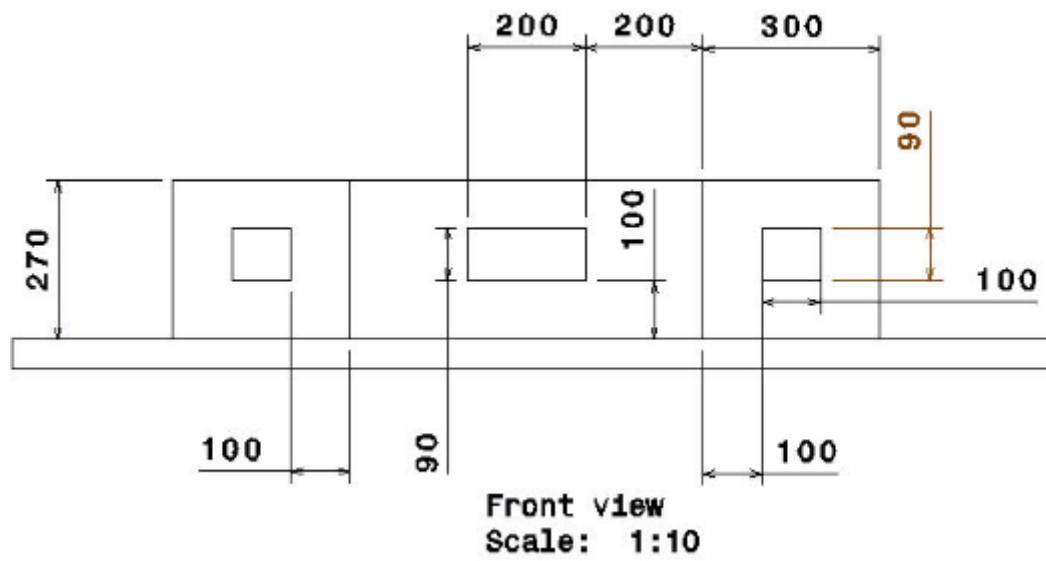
Dimensiones del alzado del módulo.
